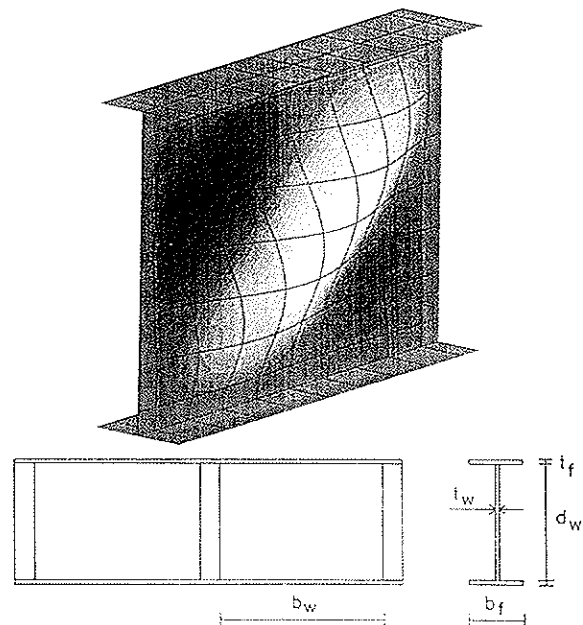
Viga armada en doble T, abollada por una carga puntual en el rigidizador central. Notación de la geometría de las vigas analizadas.
